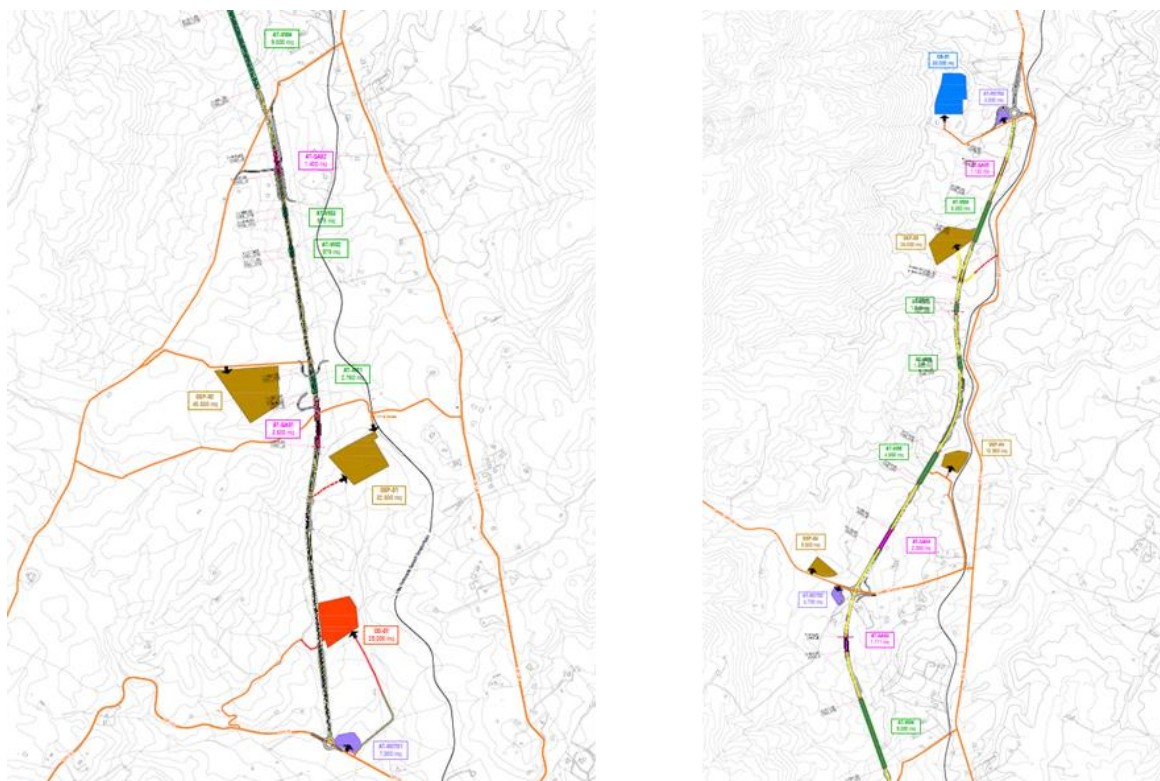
Localizzazione delle aree di cantiere rispetto il tracciato di progetto
